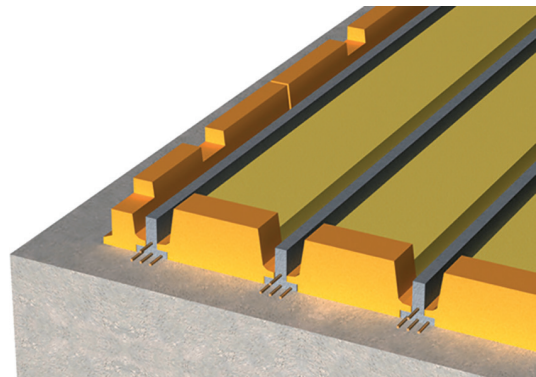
Plancher à poutrelles équipé de rupteurs longitudinaux et de rupteurs transversaux
